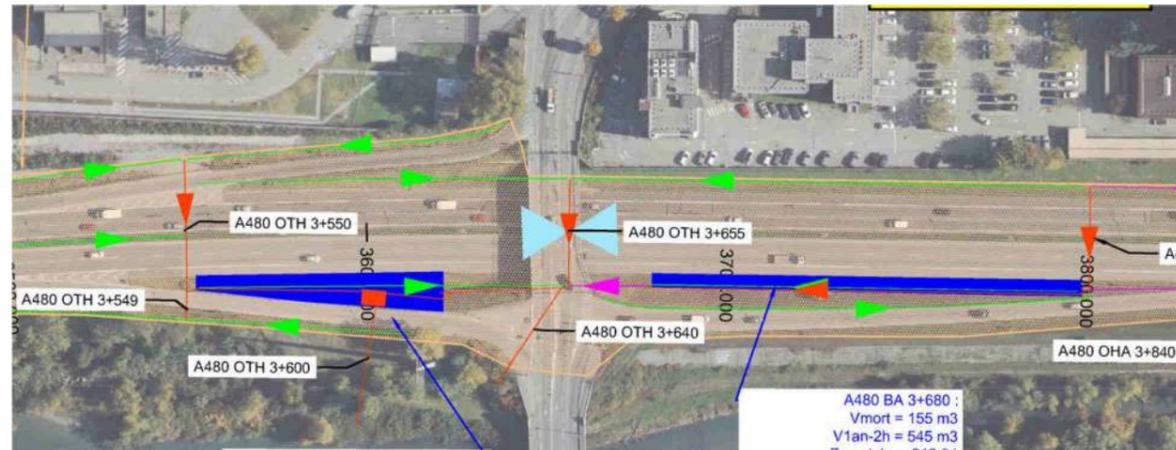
Zoom sur le dispositif d'assainissement au droit de Vercors : OTH 3+640
